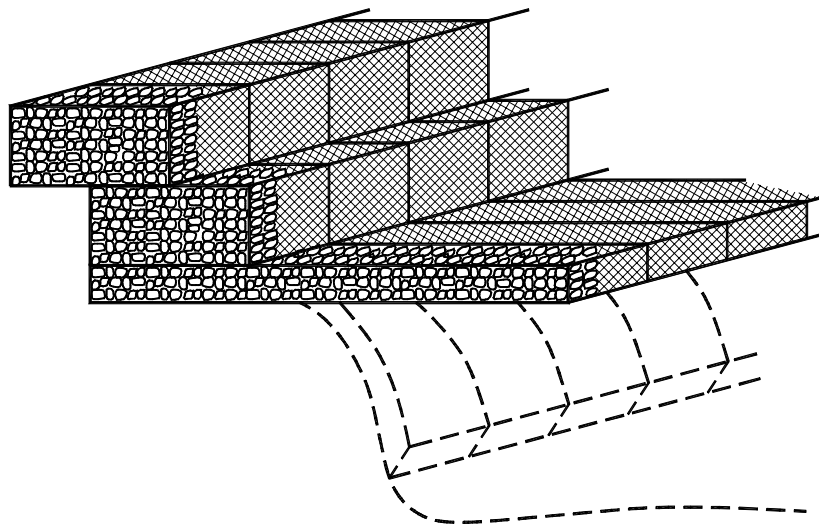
Muros en gaviones para protección de orillas de corrientes.
